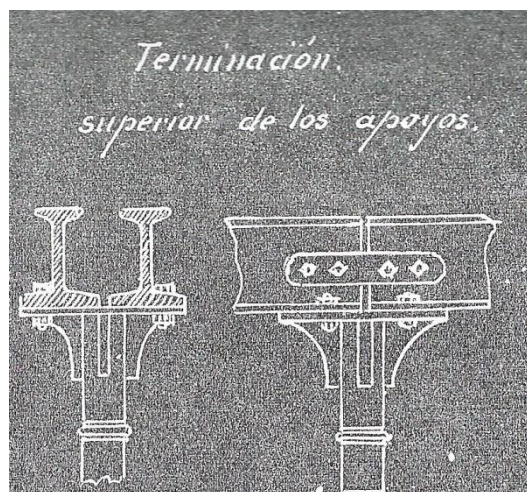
Detalle de capitel de columna de fundición y apoyo de perfiles de acero laminado. Fuente: (Anónimo, 1909).
